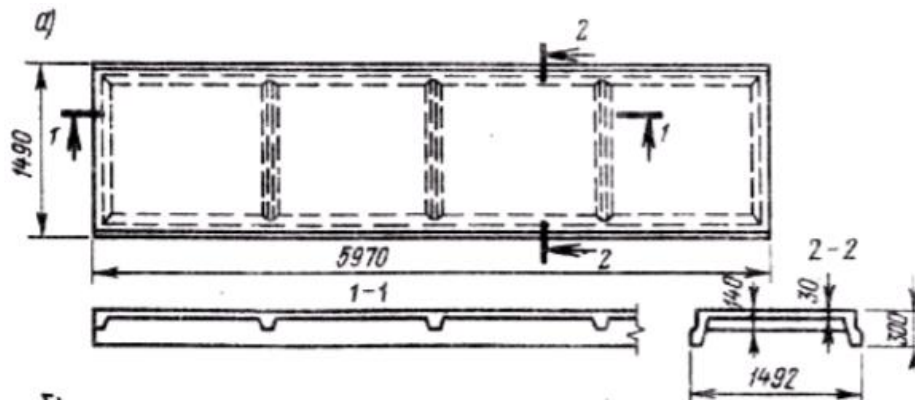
Залізобетонна плита покриття розмірами 1.5х6 м
